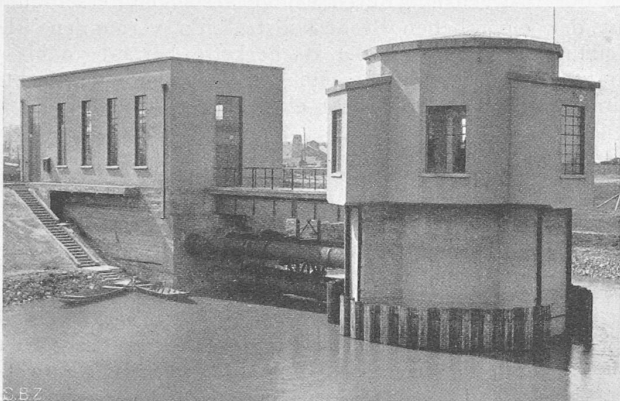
Links Filterhaus, rechts Pumpenhaus der Wasserfassung.
